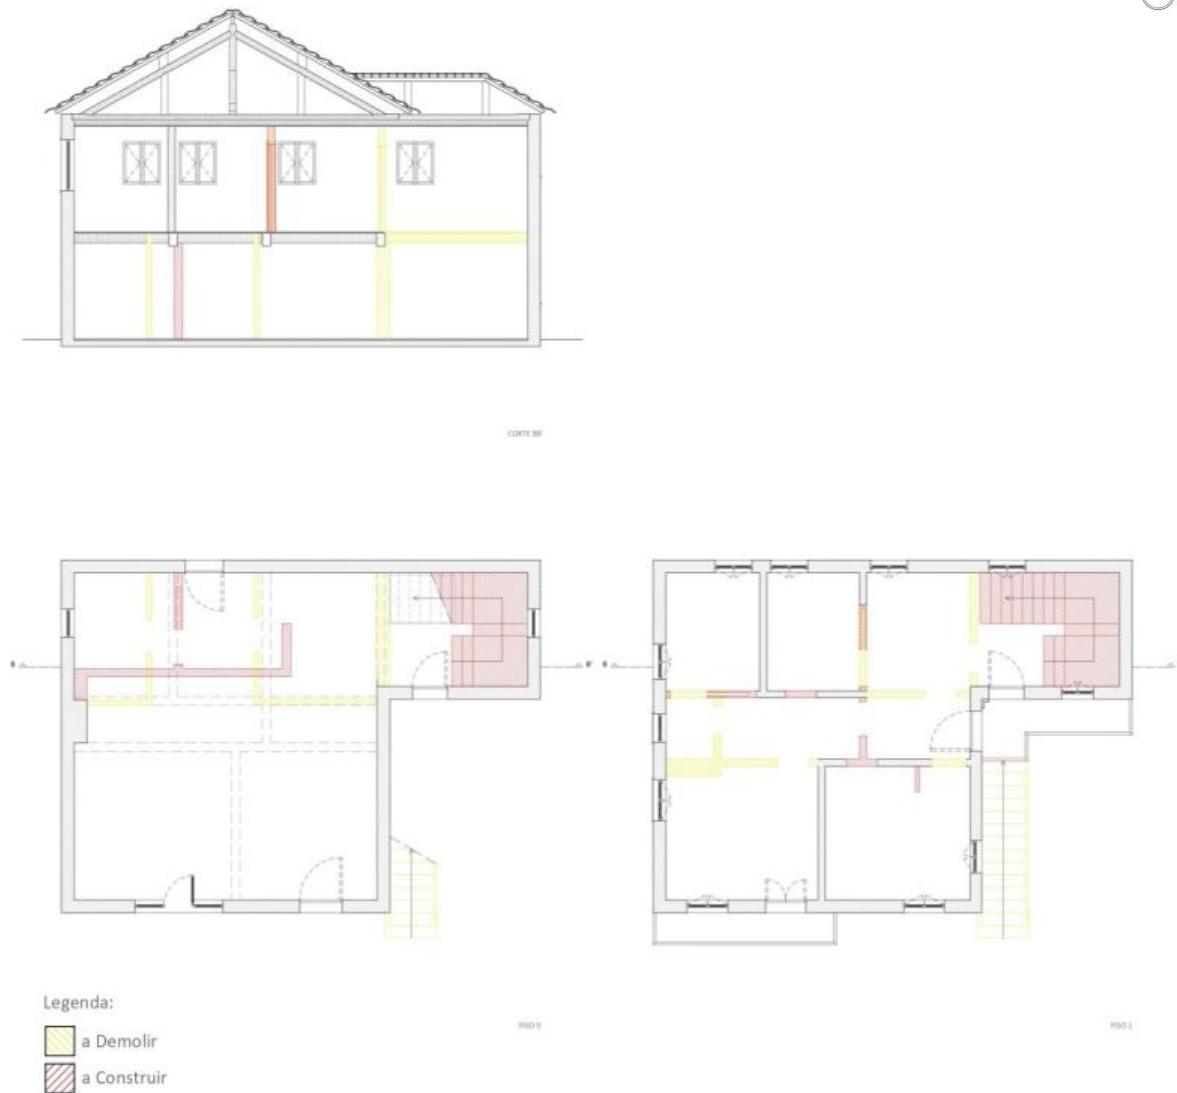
Plantas de Alteração do Piso 0 e Piso 1, respetivamente. Fonte: Autor
